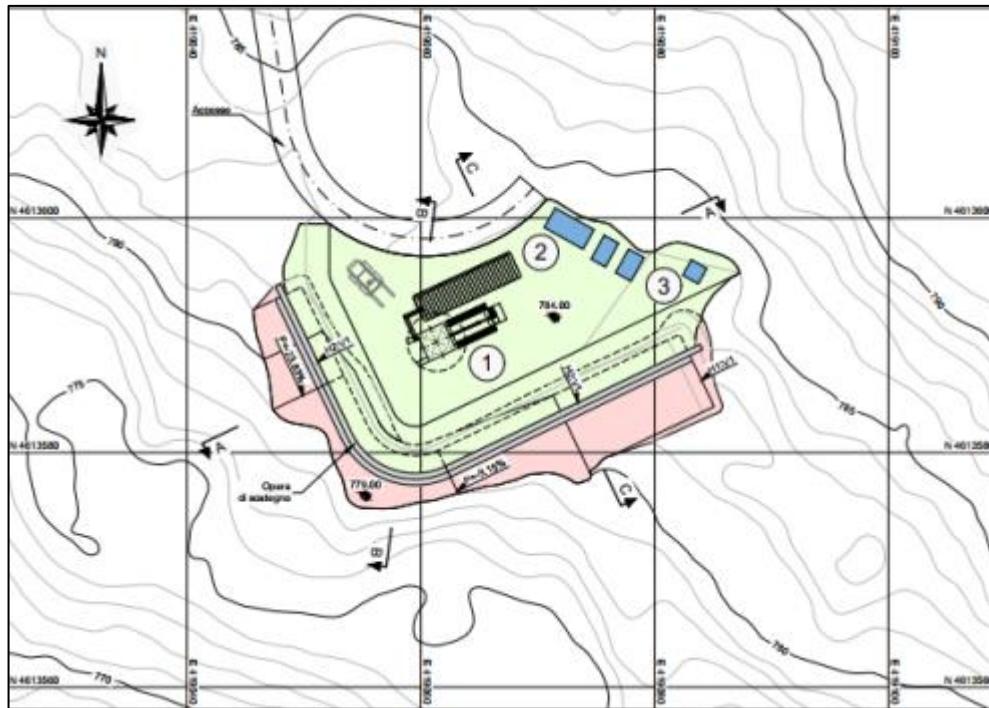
Ambito Pizzone - Area di cantiere CA.PV – Pozzo estrazione fumi della centrale
